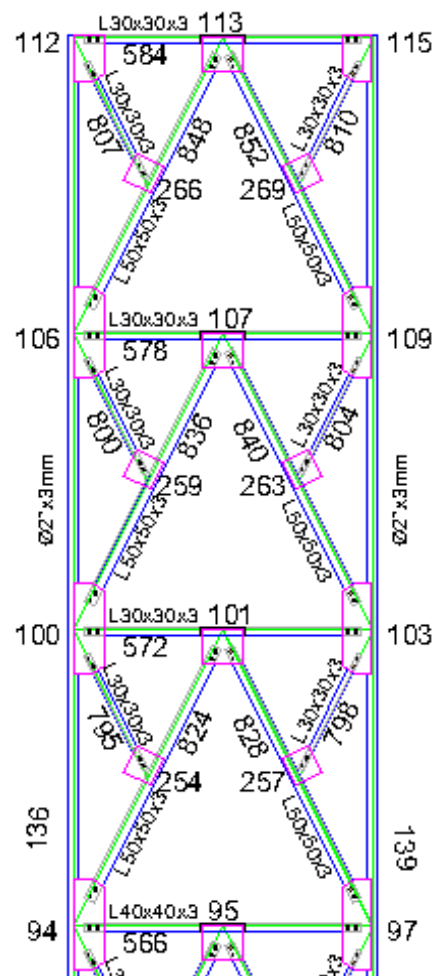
Unión de elementos metálicos en la parte alta de la torre
